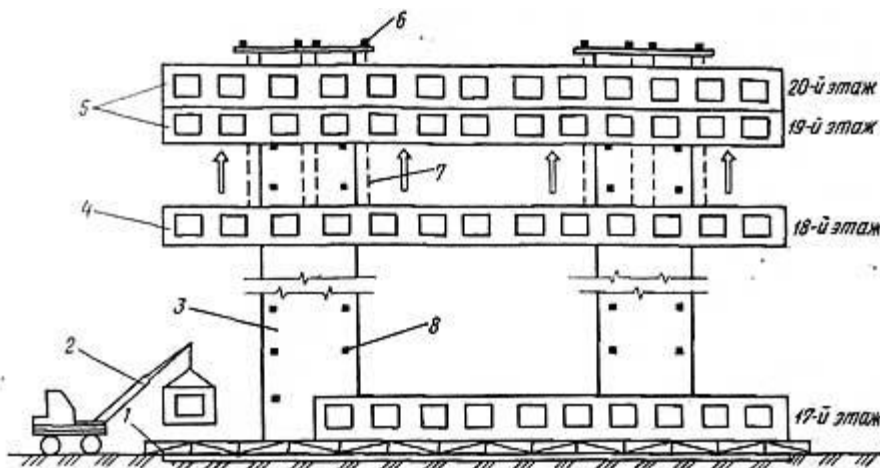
Схема монтажа 20-этажного здания методом подъема этажей: 1 — подмости-кондуктор для сборки перекрытия; 2 — кран на монтаже панели; 3 — железобетонная башня; 4 — этаж в процессе подъема; 5 — этажи в проектном положении; 6 — крепление домкратов; 7 — тяги; 8 — отверстия для крепления этажей
